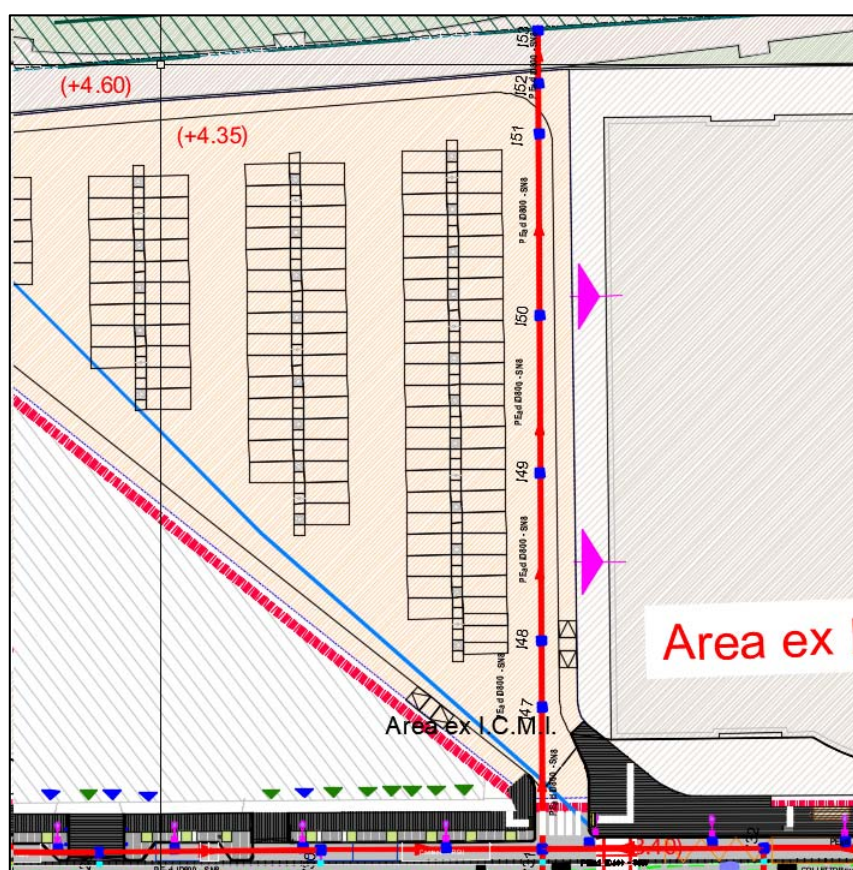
Collegamento rete di smaltimento acque meteoriche di progetto con il Collettore dello Sperone (attraversando il parcheggio P1 dell'area ex I.C.M.i)
